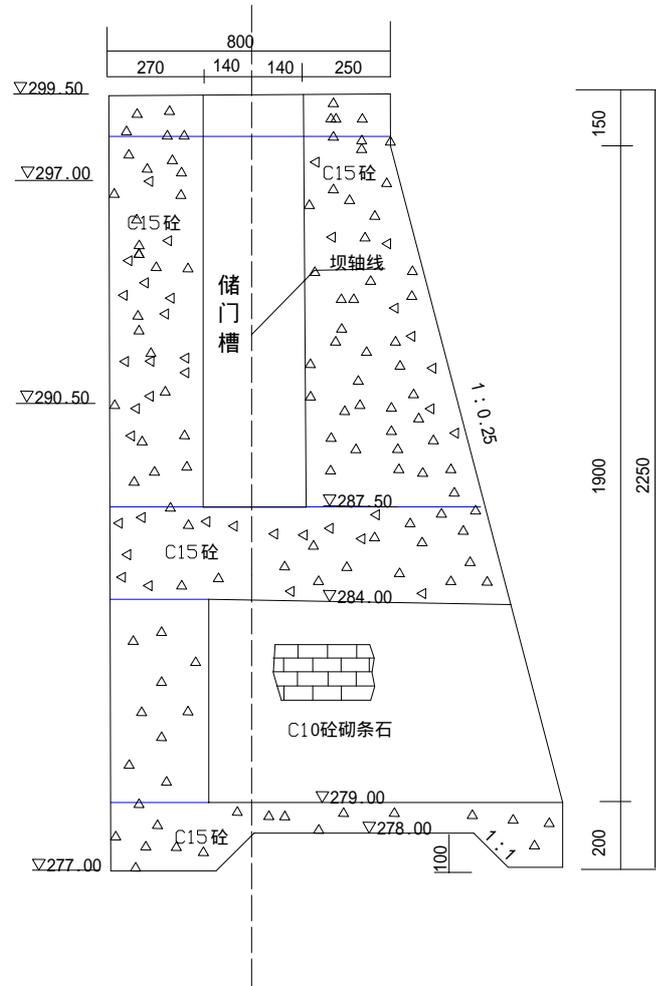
非溢流坝混凝土浇筑分层示意图
